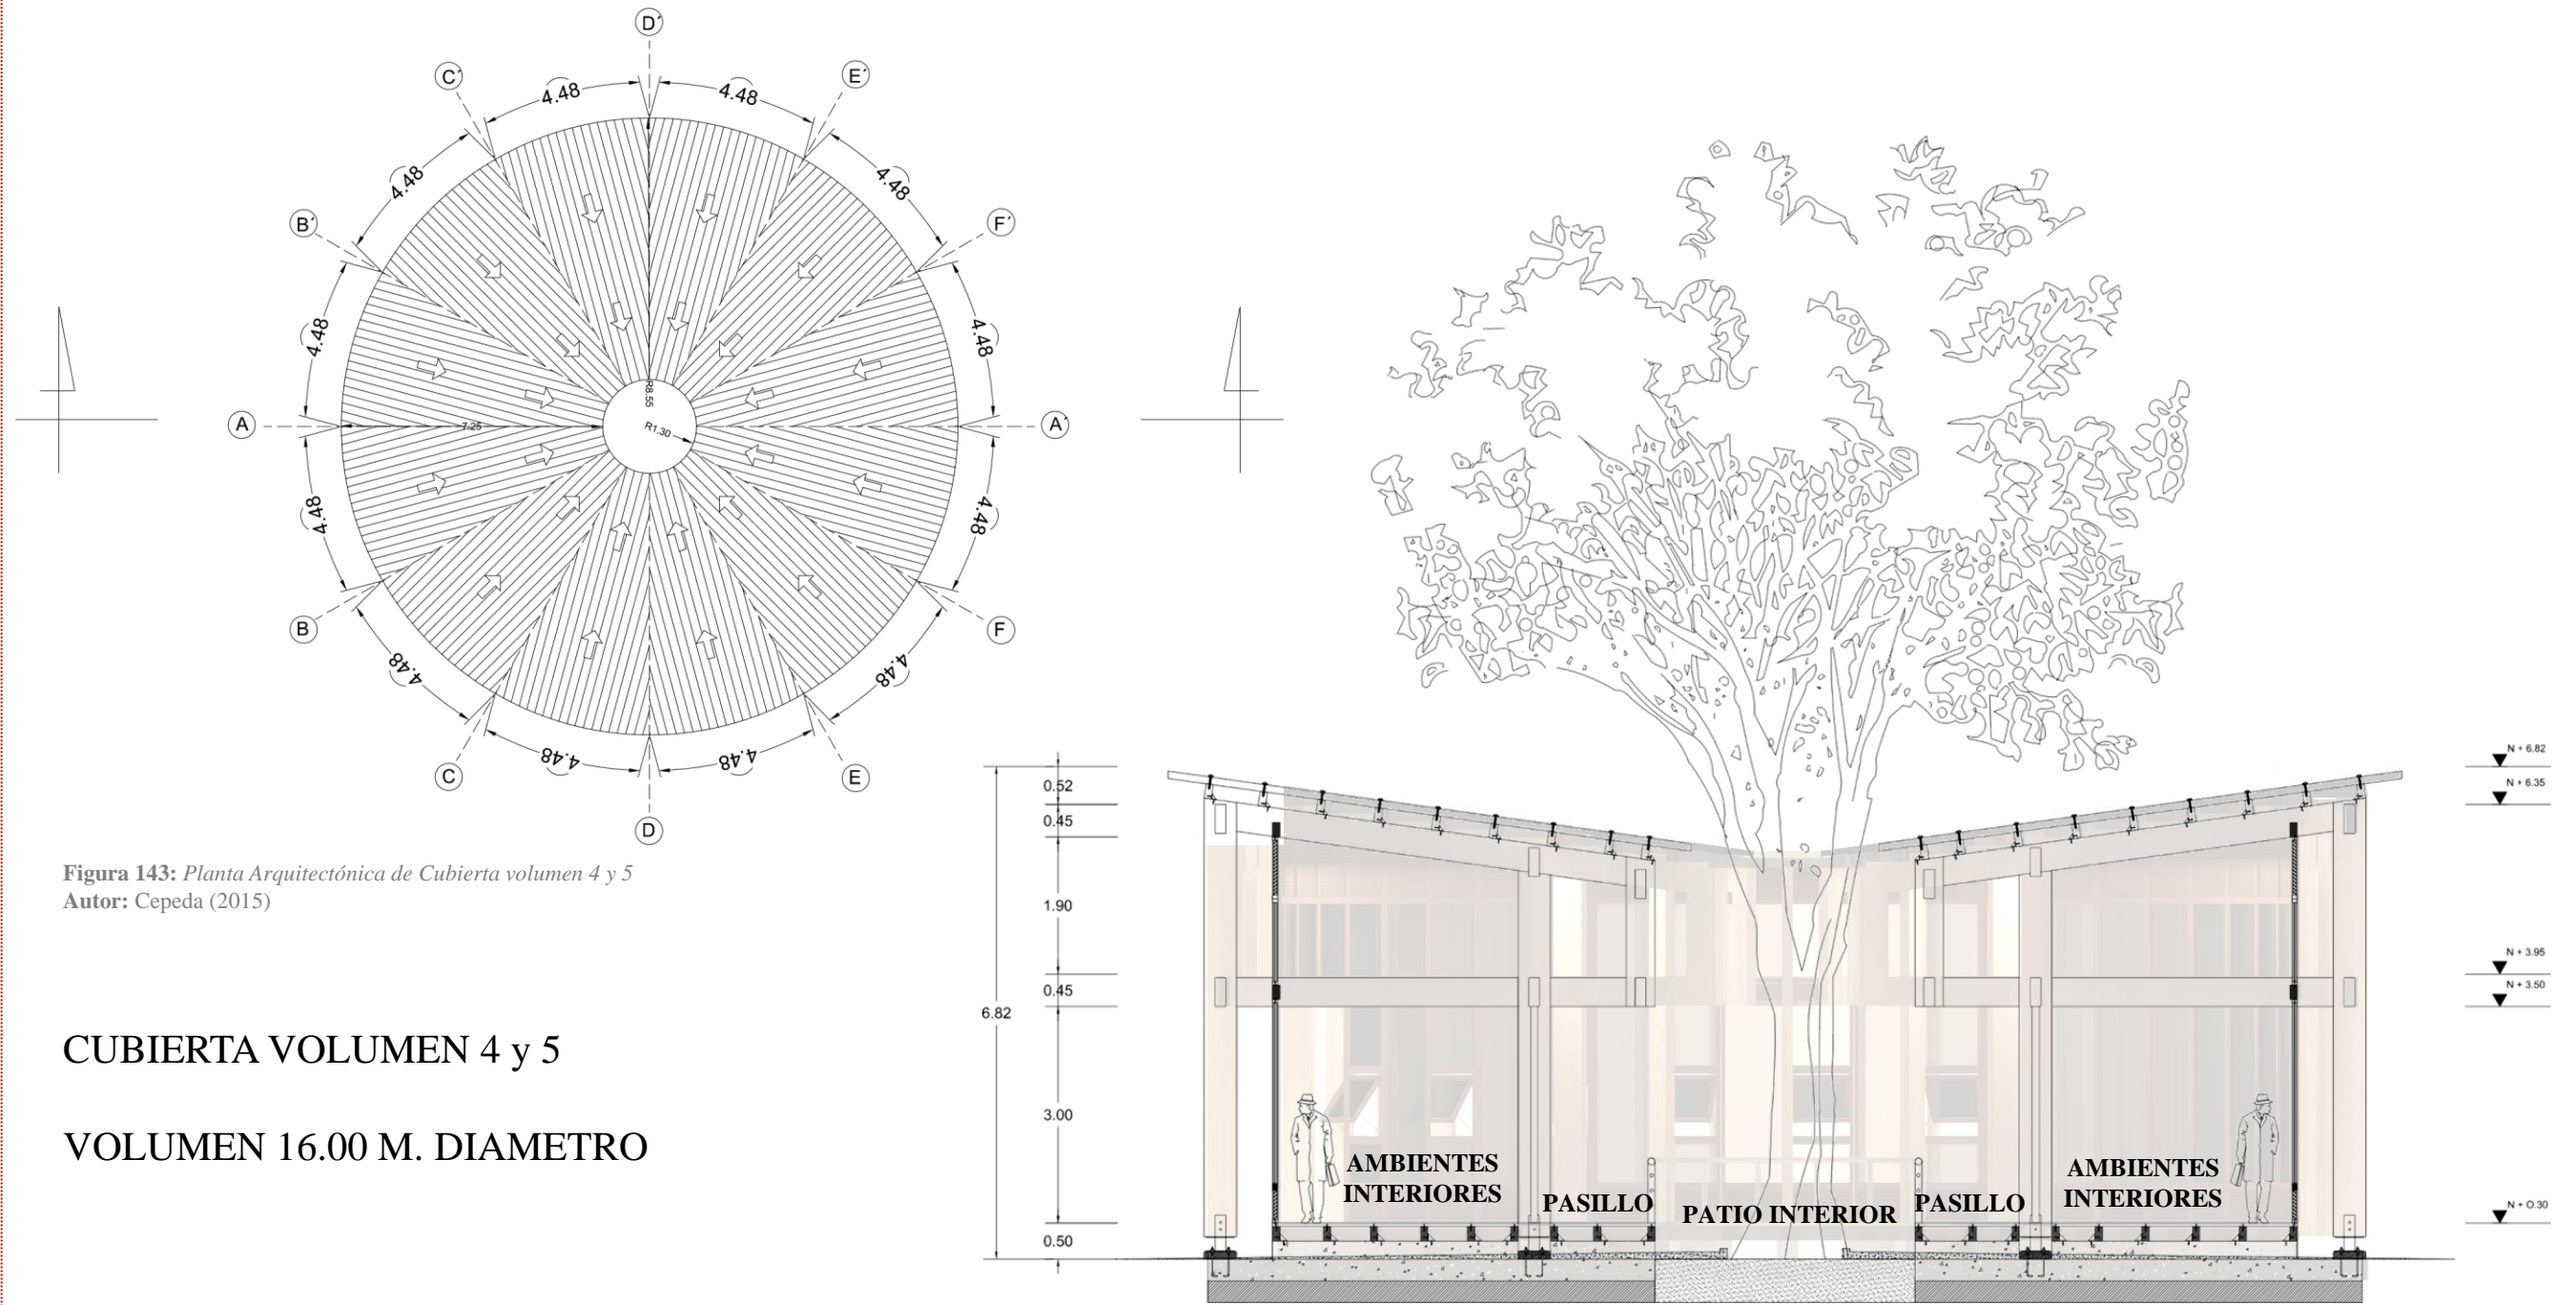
Planta Arquitectónica de Cubierta volumen 4 y 5
